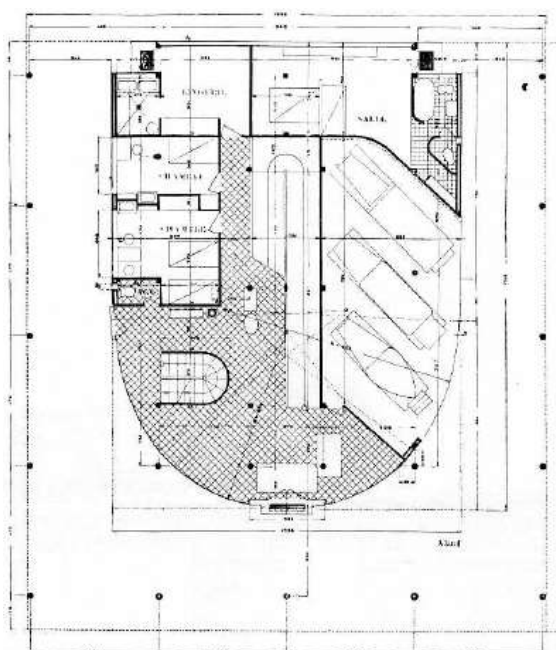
Planta do térreo da Villa Savoye, em Poissy
